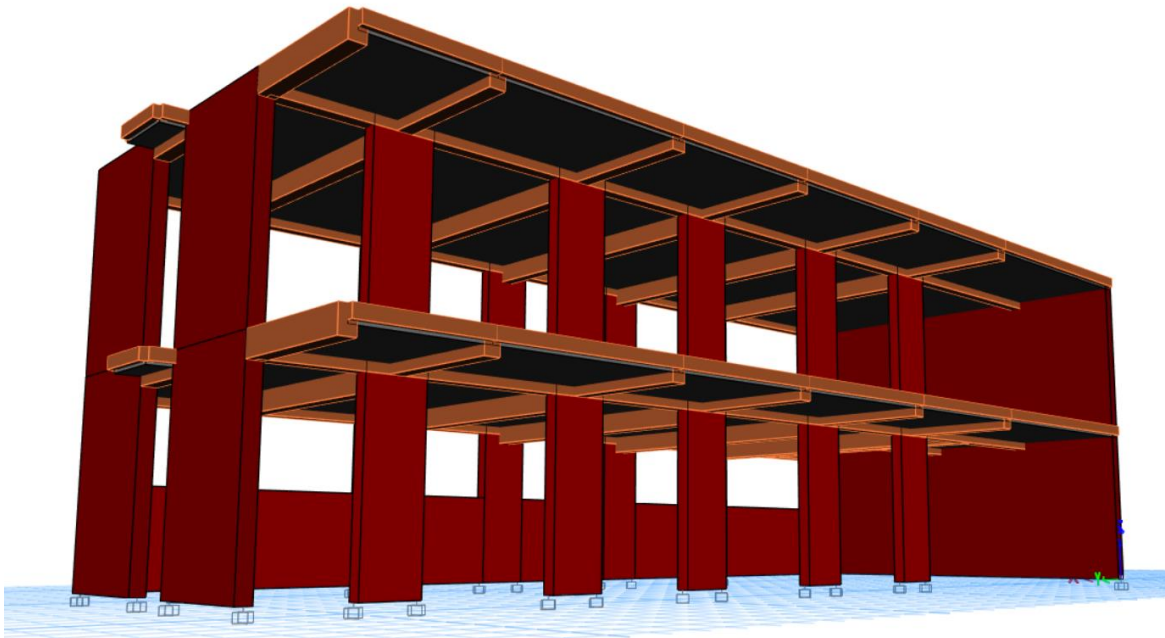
Vista 3D estructural 2 del bloque de dormitorios y circulación vertical y horizontal. ETABS. V.20.3.0.
